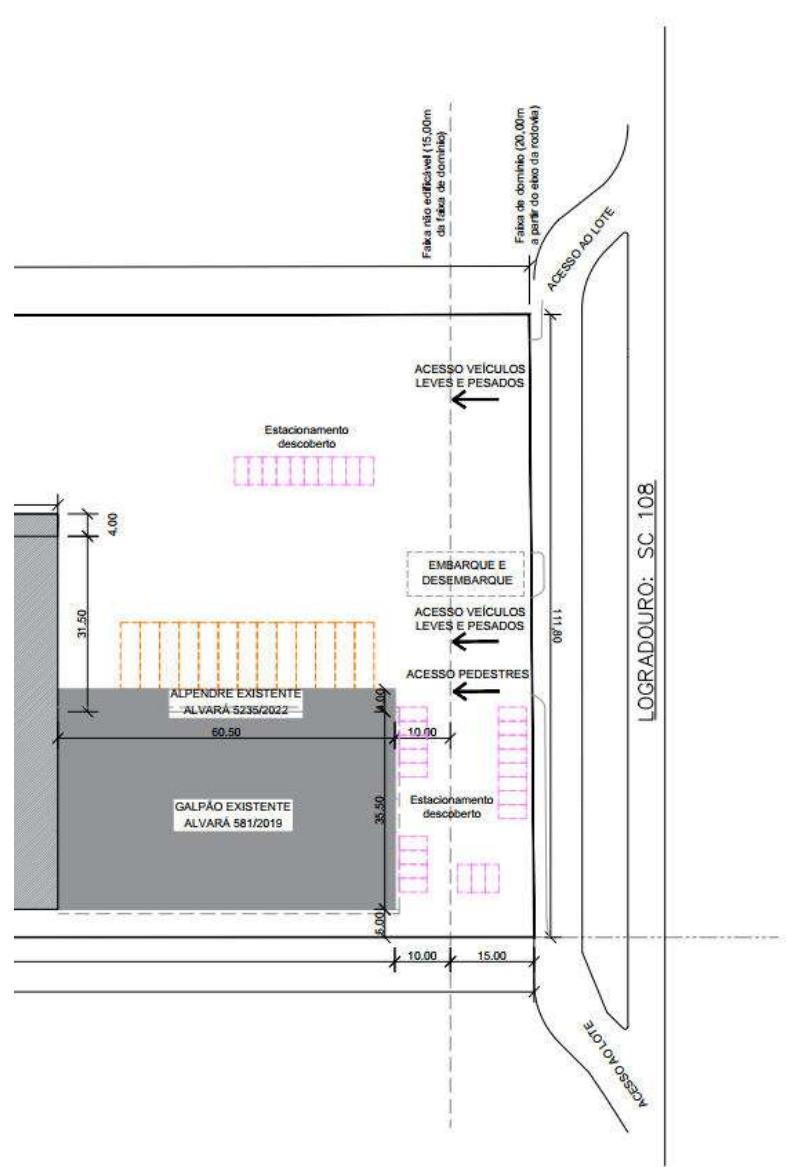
Recorte da planta de implantação com detalhes do acesso a veículos e pedestres
